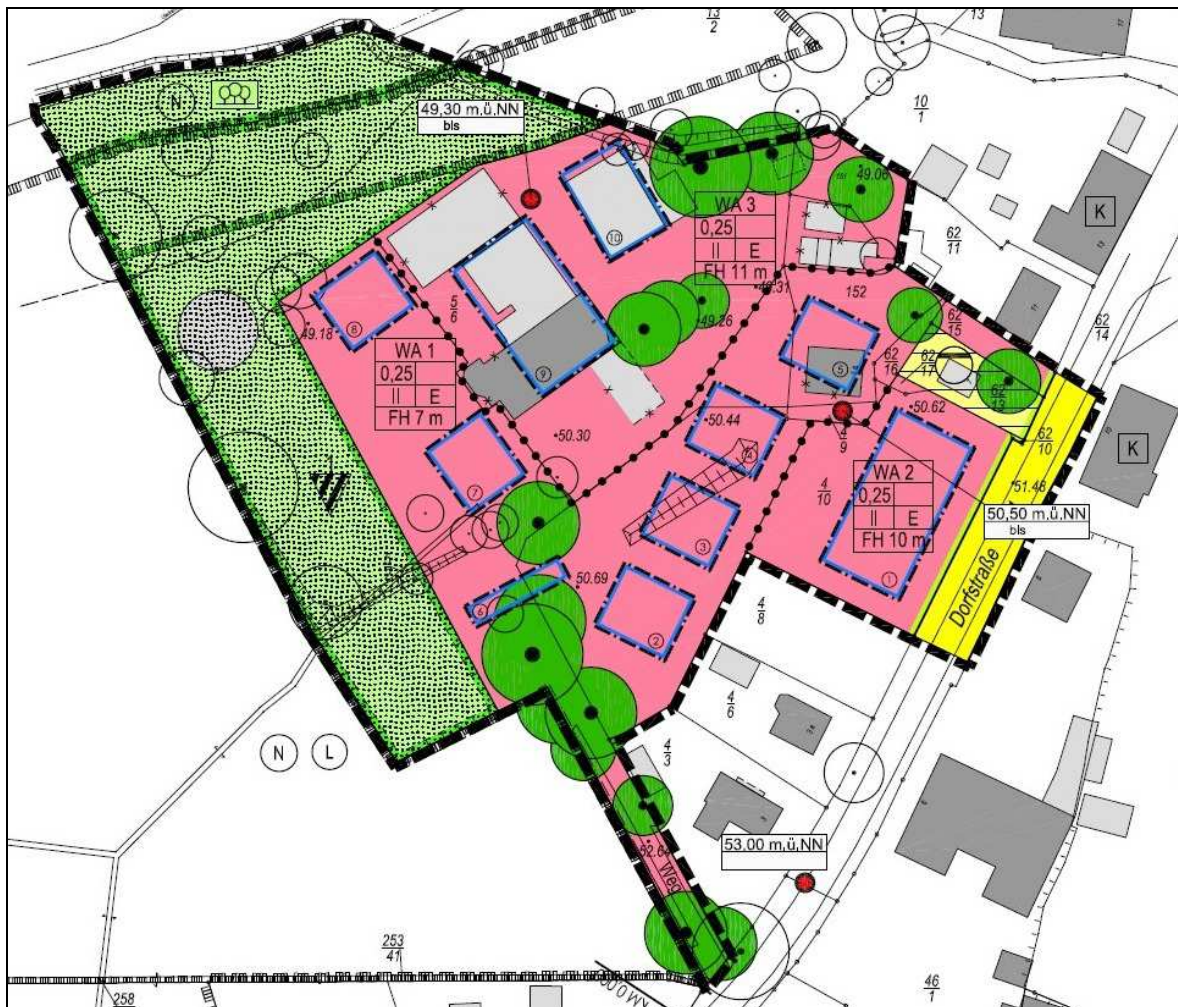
Bebauungsplan-Entwurf (Stand 14.12.2016)
